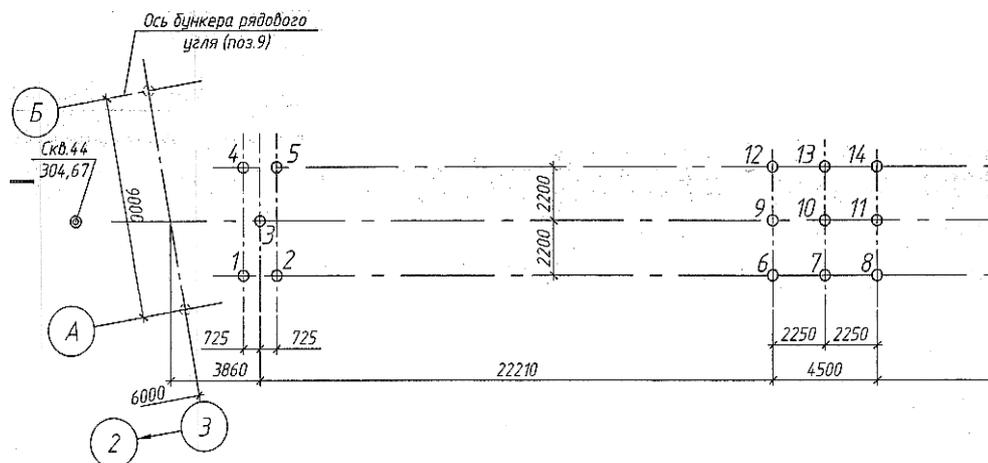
Фрагмент плана свайного поля с опытными сваями: № 6, № 9, № 12
